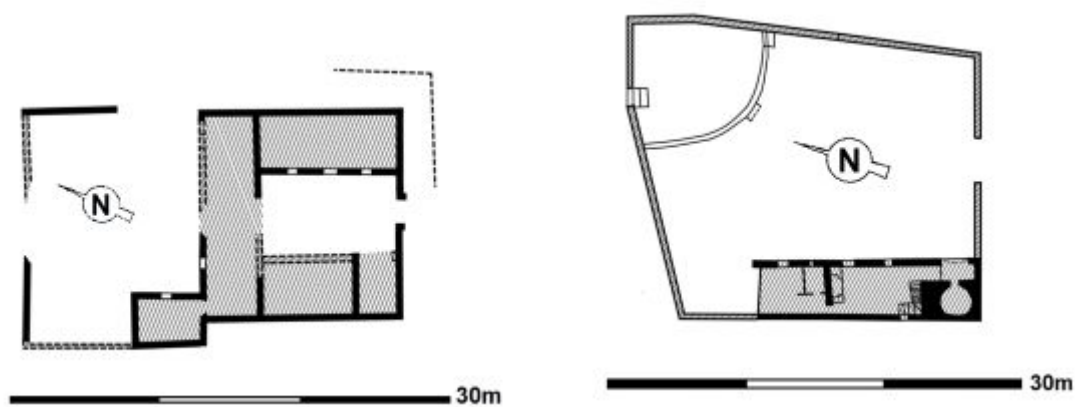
Planta de la casa forestal de las Minas, zona republicana, Fidel Baena.
